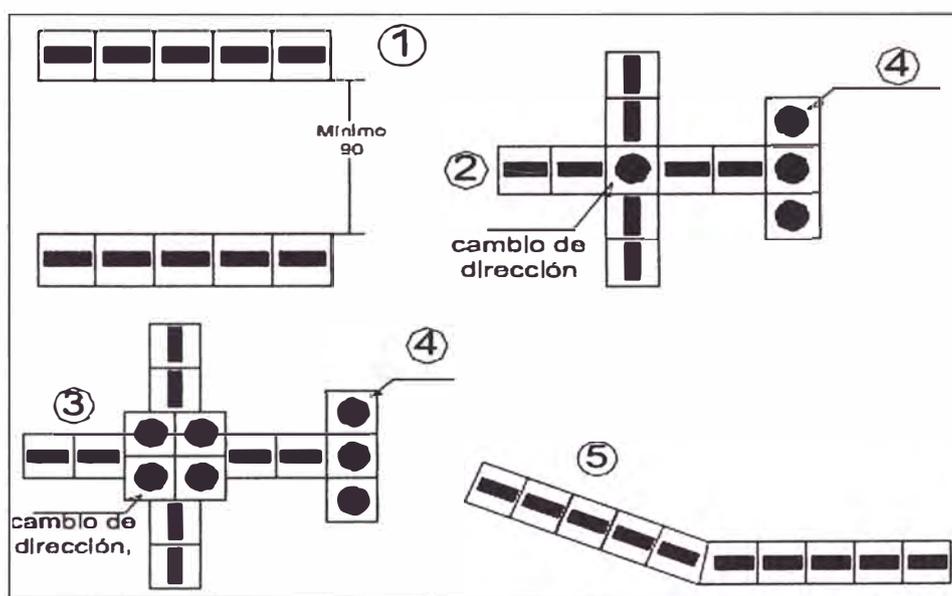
Orientación y tipo de pavimento de ruta táctil.
